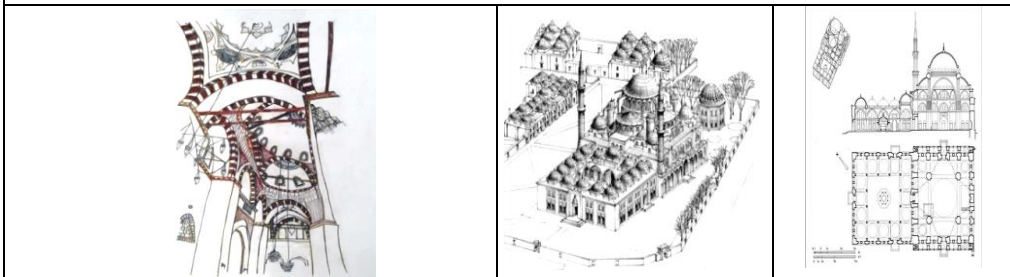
مسقط أفقي ومنظور لجامع مهران في اسكدار باستانبول يوضح السقيفة المزدوجة التي تتقدمه. (عن: كوران بتصرف).
